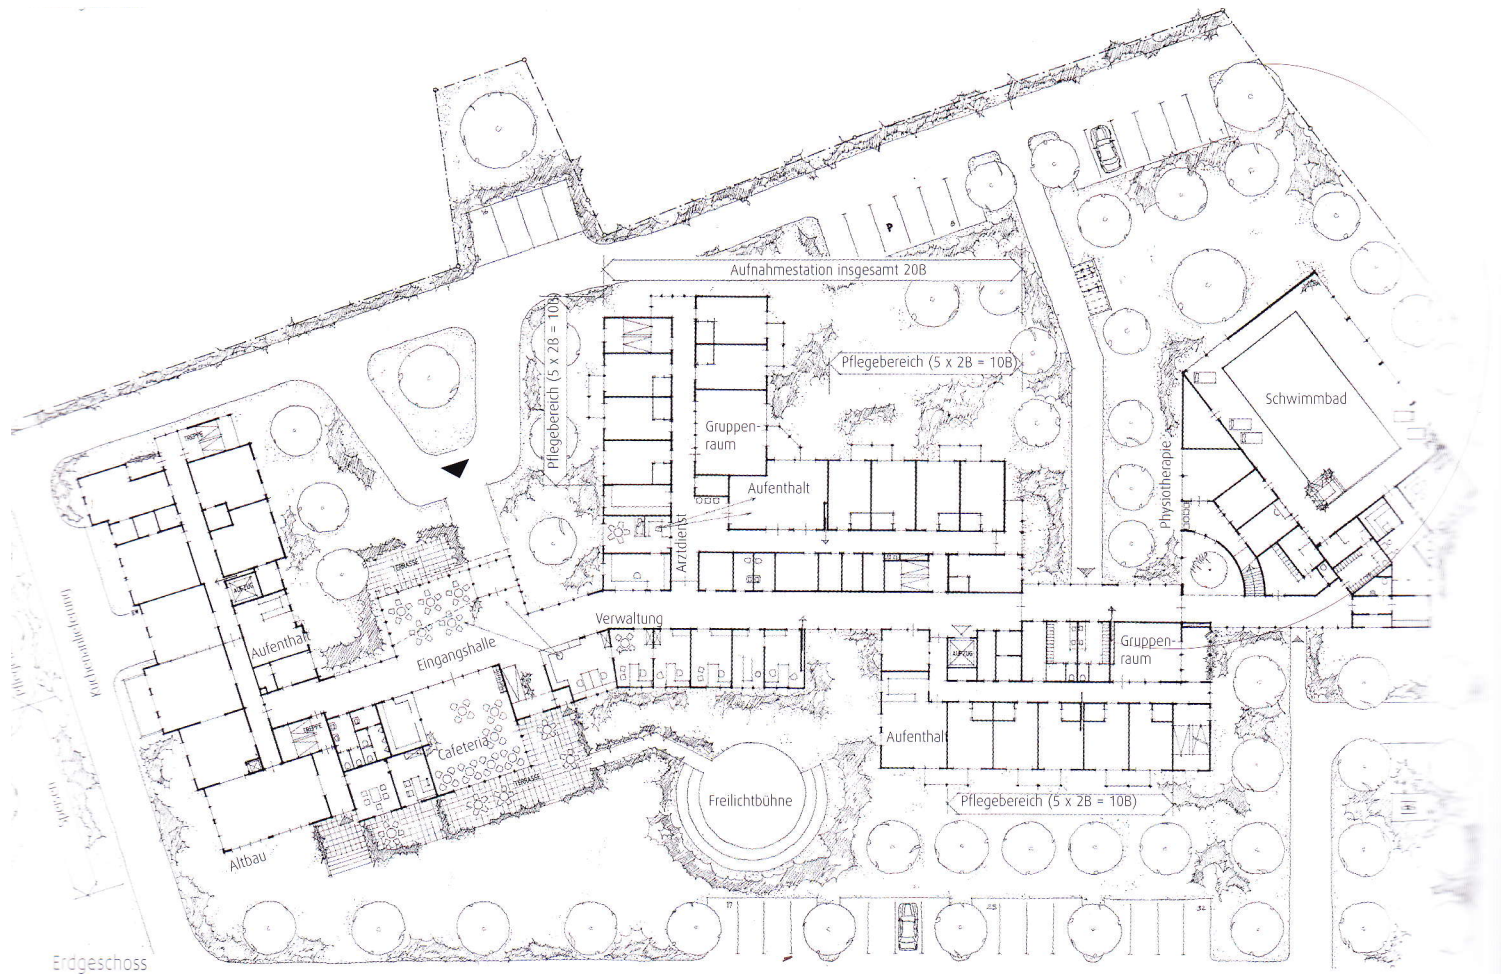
RJ Planungsbüro Fachklinik Klosterwald, Grundriss Erdgeschoss, M 1:700
